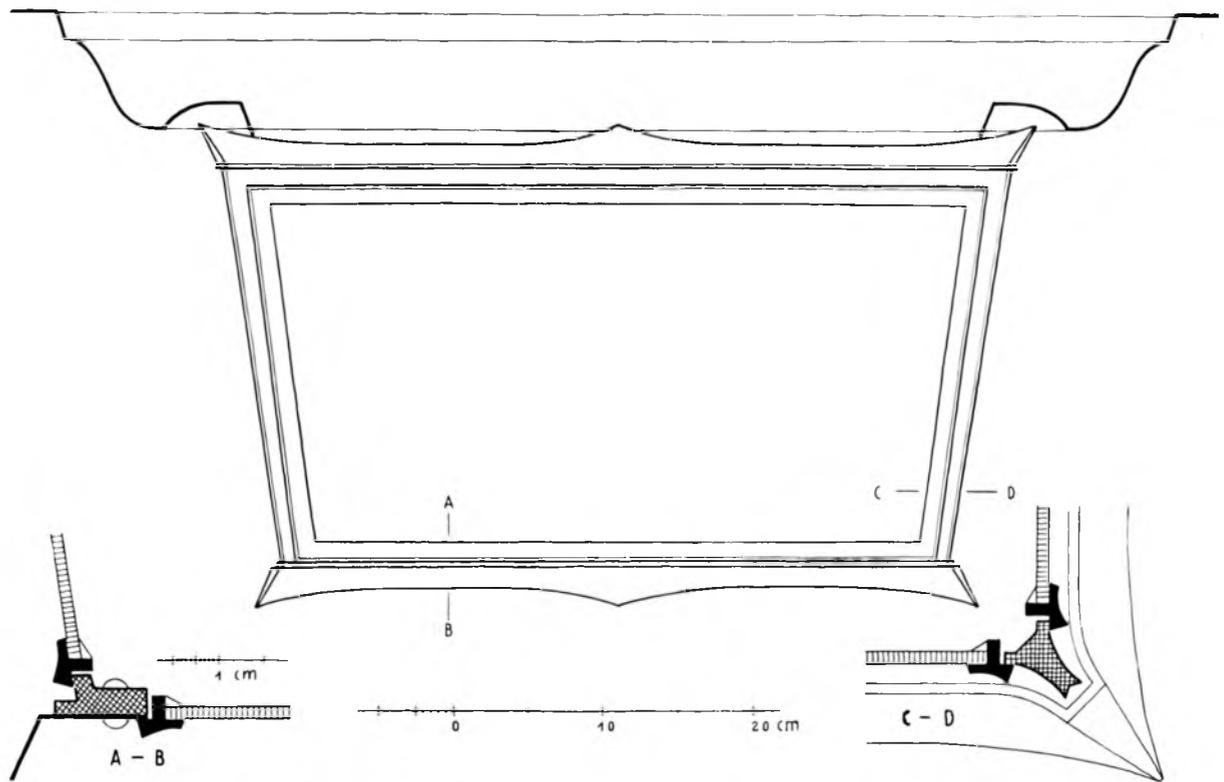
Deckenbeleuchtung der Umgänge in der Haupthalle, links Schnitt A—B, rechts Grundriß C—D
